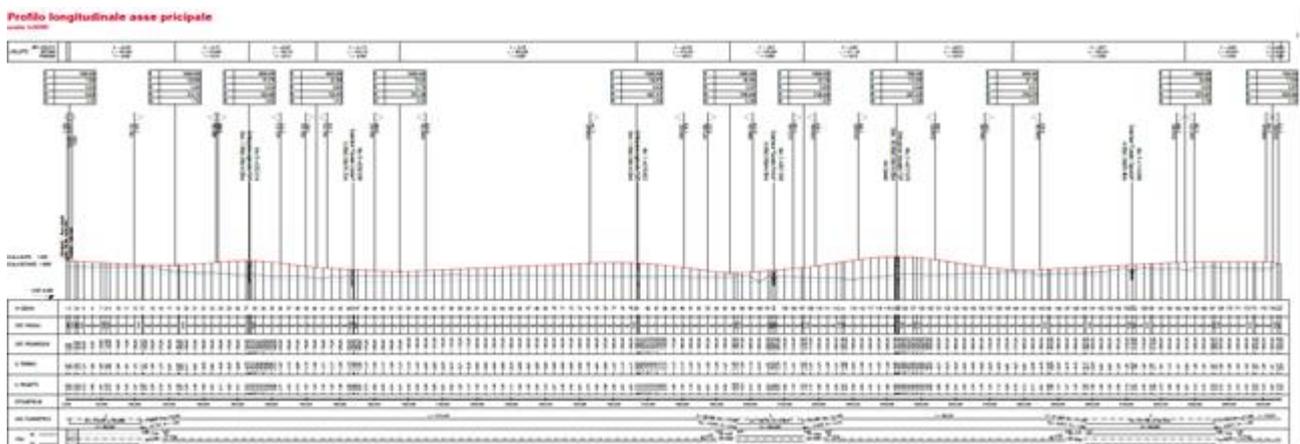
PROFILO DELL'INFRASTRUTTURA DI PROGETTO
